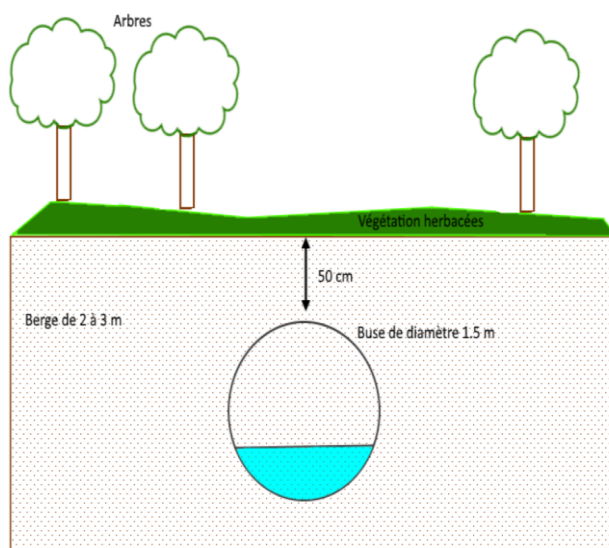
Situation schématique avant travaux - vu en coupe transversale.
